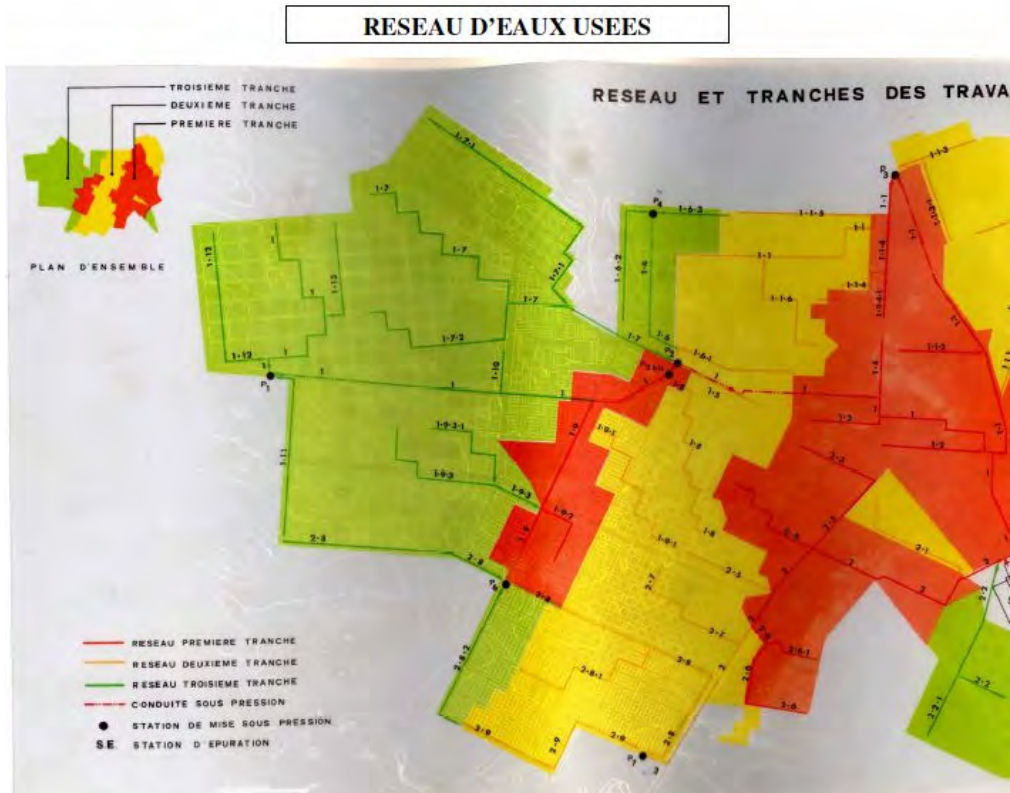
Plan de réseau d'assainissement (Plan cadre d'assainissement de la Ville de Kaolack, 1979)
